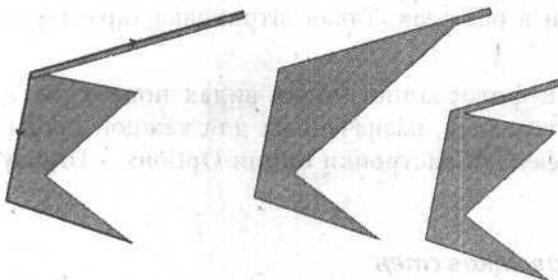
Выполнение углов полистен и углов соединения стены с многоугольником стен
